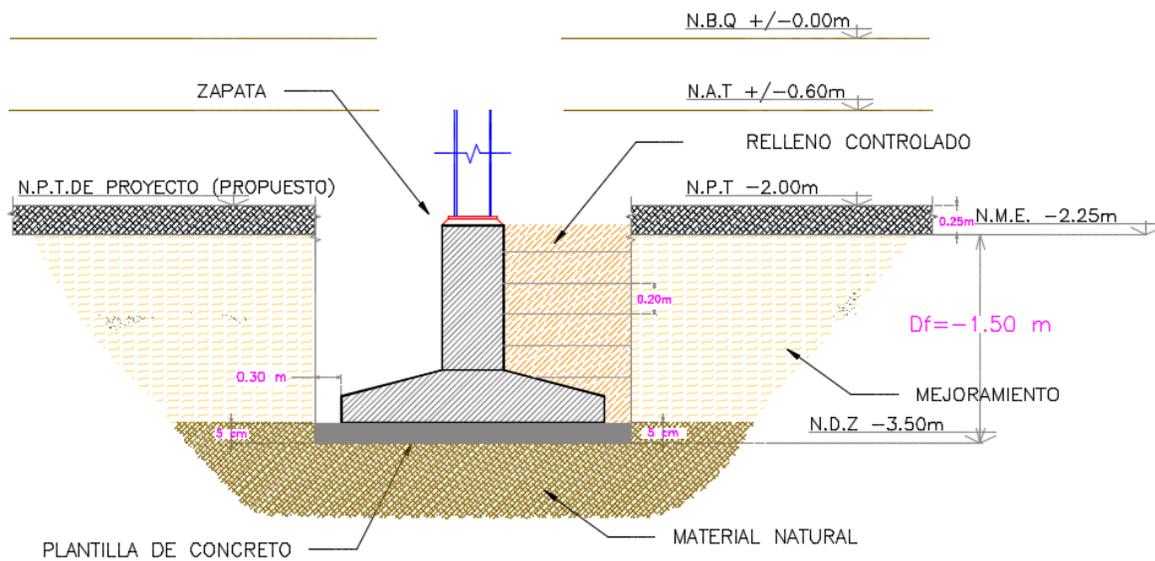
ALTERNATIVA DE CIMENTACIÓN MEDIANTE ZAPATAS AISLADAS CENTRALES Y ZAPATAS CORRIDAS APOYADAS SOBRE MATERIAL NATURAL
